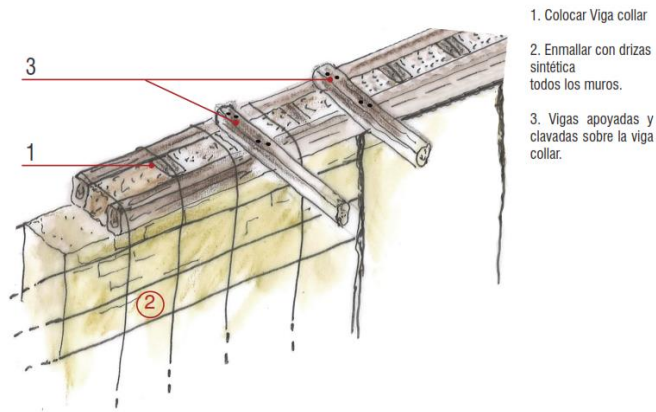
Para mejorar el apoyo de las vigas se recomienda elaborar una viga collar.
